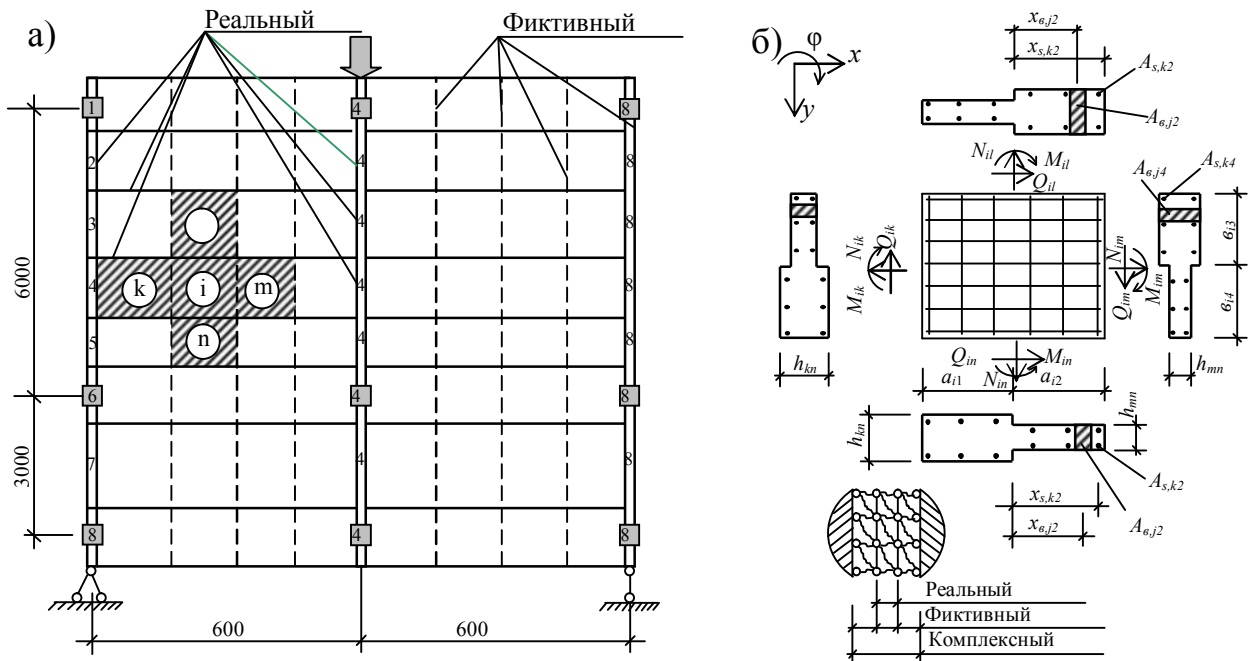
Расчетная схема сборного перекрытия: а) разбивка на элементы; б) Модель МСД для железобетона при плоском напряженном состоянии
